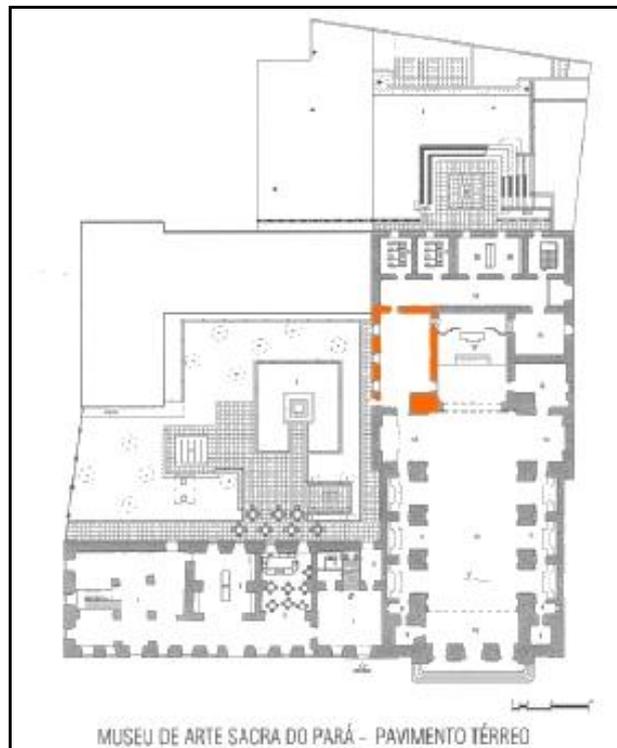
Planta baixa do pavimento térreo do Museu de Arte Sacra. Destaque para a localização da sacristia.
